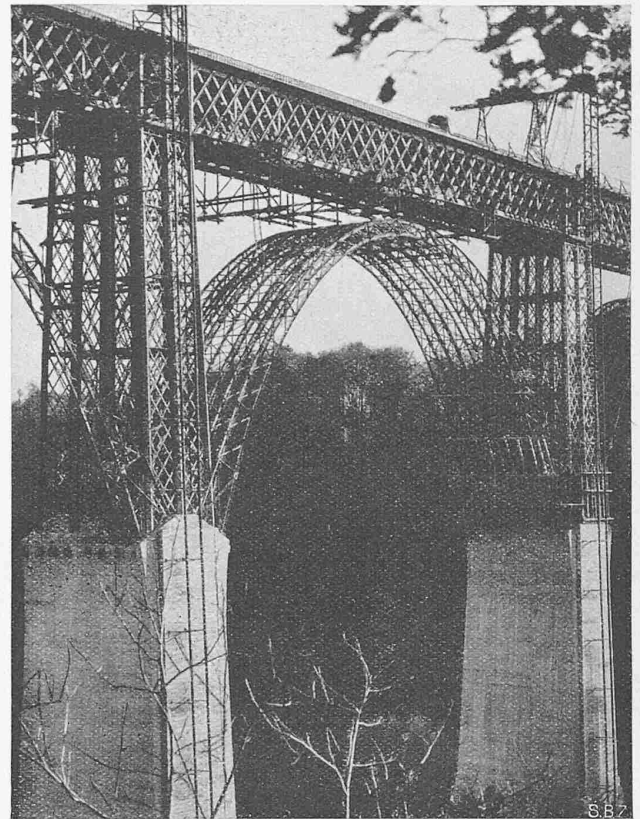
Fertig montierte Melanbogen, links Montagebeginn (Aufn. 26. Okt. 1925). Hängegerüste mit dem Gitterträger, längs der Pfeilergerüste die Betonauflage. Melan-Konstruktion von Löhle & Kern A.-G., Zürich.
